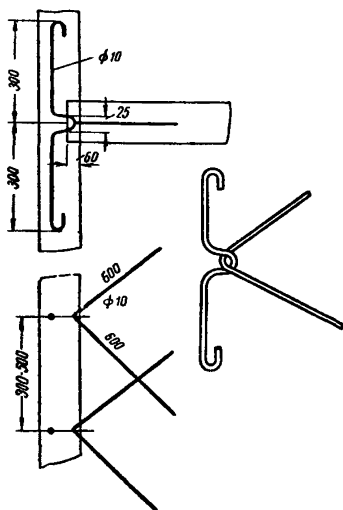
Связь плит перекрытий и днищ бункеров со стенами, возводимыми в скользящей опалубке
